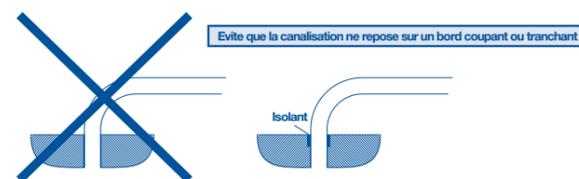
Protection des conduites Wavin Tigris émergeant d'un plancher ou d'une paroi
